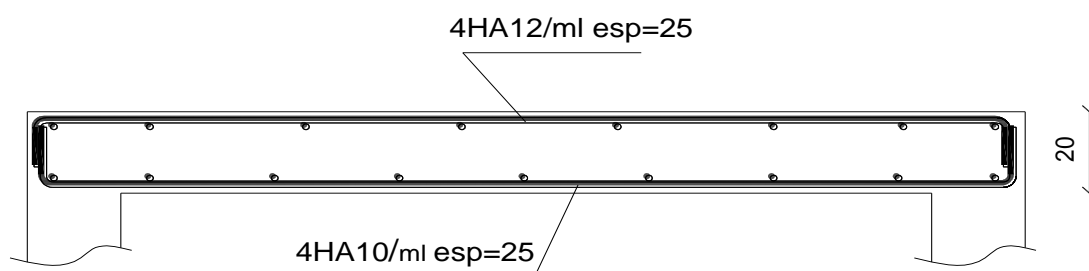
ferrailage de la dalle salle machine dans les deux sens
